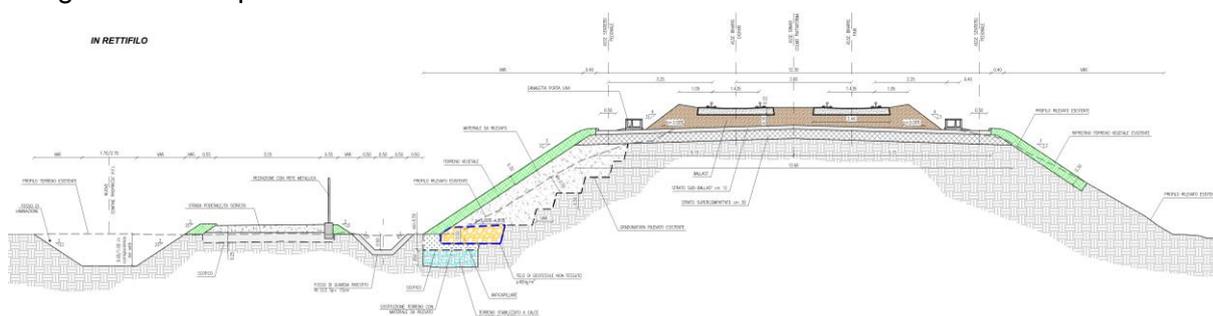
Sezione tipologica con il nuovo rilevato in sovrapposizione all'esistente
